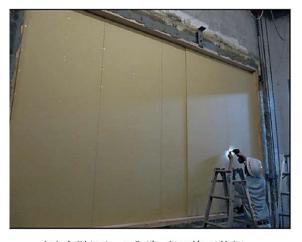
試験体の施工状況 (試験体 No.6~No.7)
